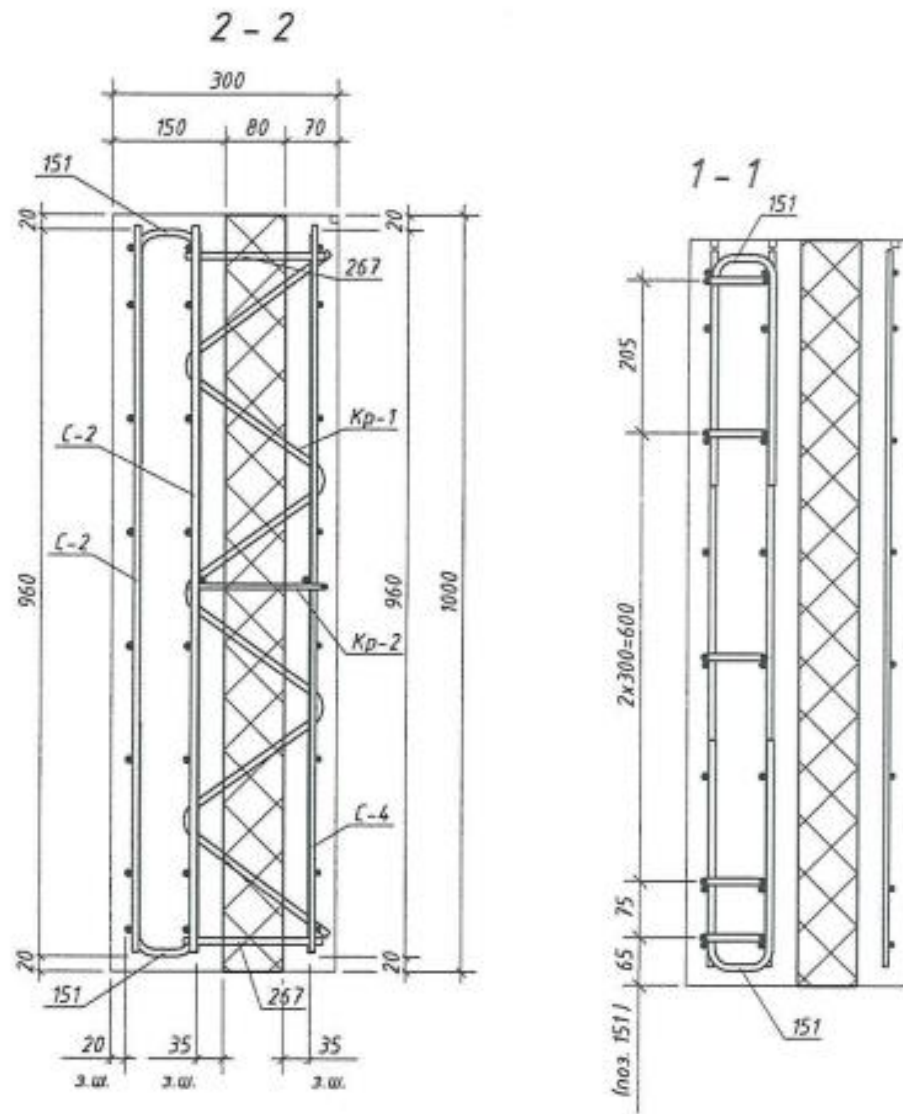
Схема армування тришарової сінової панелі цокольної ПЦ 63
